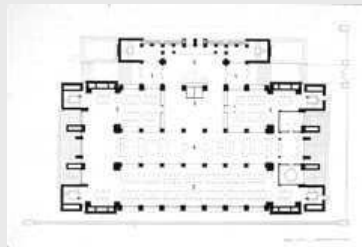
e 2.10 Planta baixa e exterior. The Larkin Company Administrative Building. Frank Lloyd Wright. 1904.
